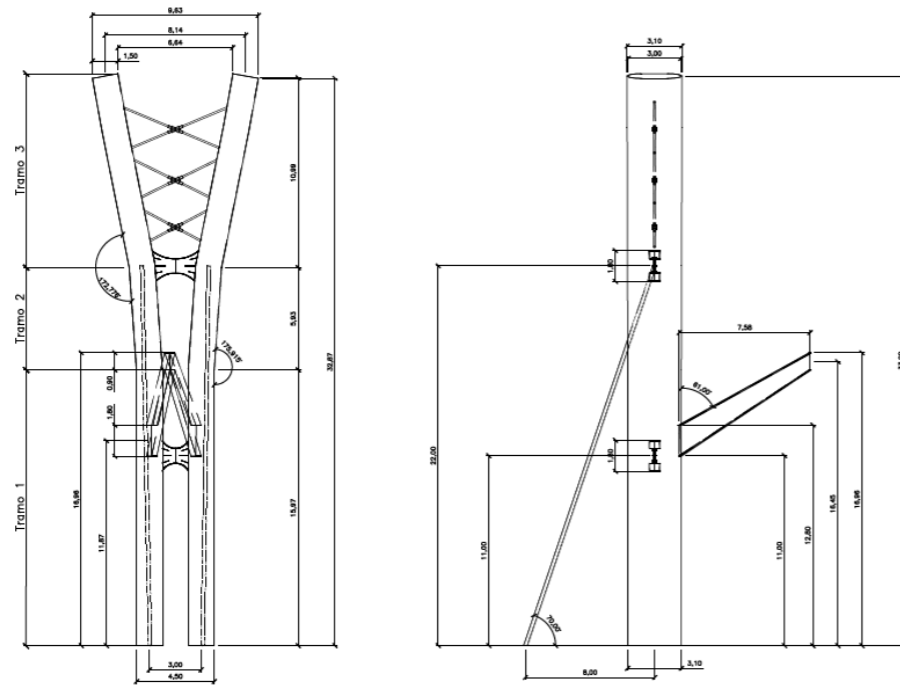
Geometría global de los elementos estructurales de las torres. Fuente: Elaboración Propia (AutoCAD)
